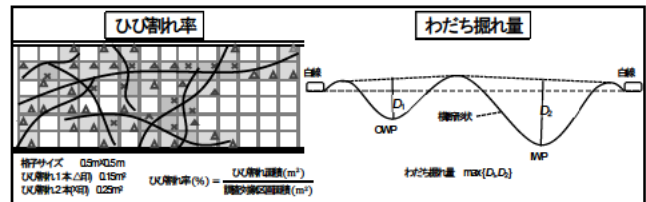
ひび割れ率・わだち掘れ量 算出方法²⁾
